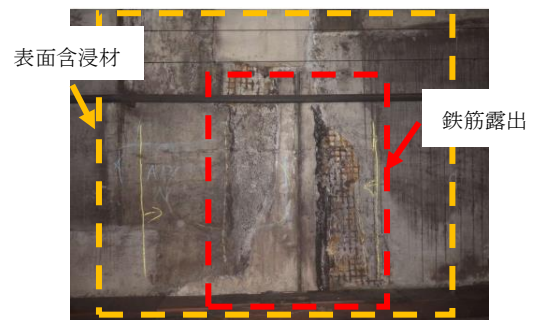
表面含浸材塗布箇所の鉄筋露出部 (A線 12k535m)
